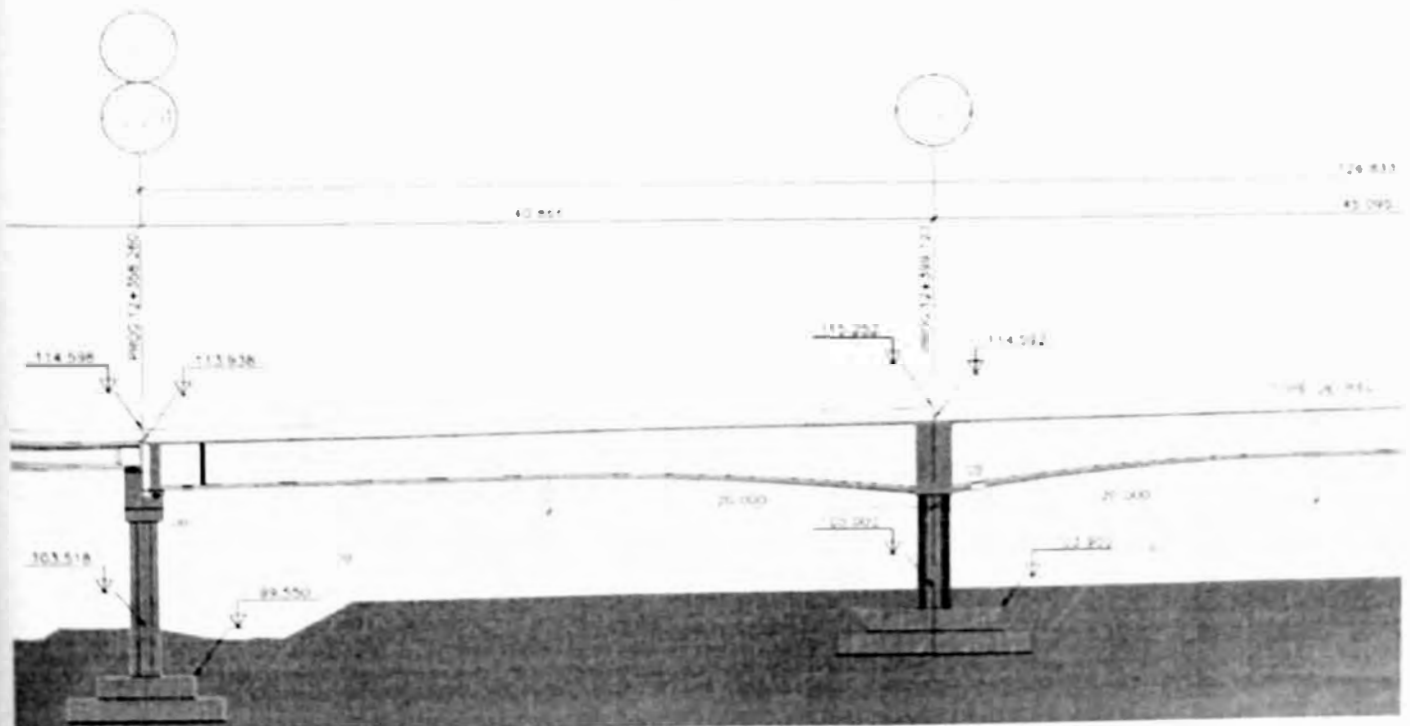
Corte Longitudinal de la Obra (ejes 224 y 225)
